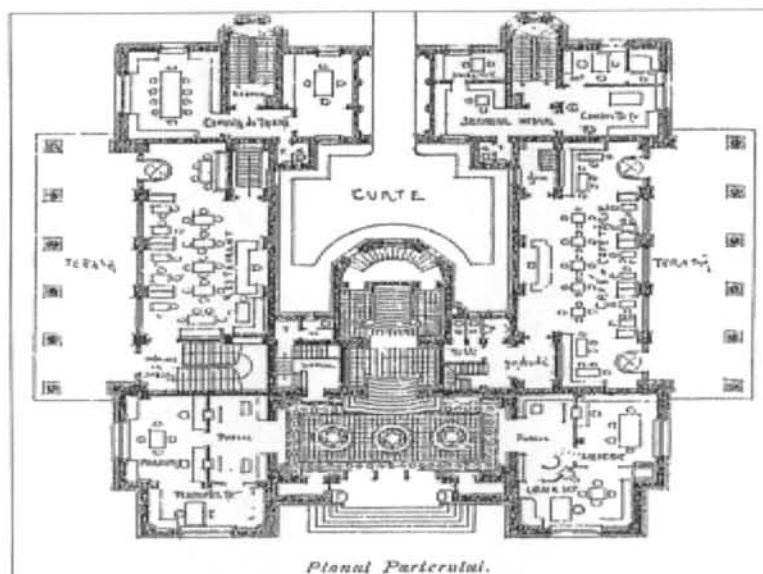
Palatul comunal din Constanța. Plan parter (revista „Arhitectura” nr.3, 1919)
